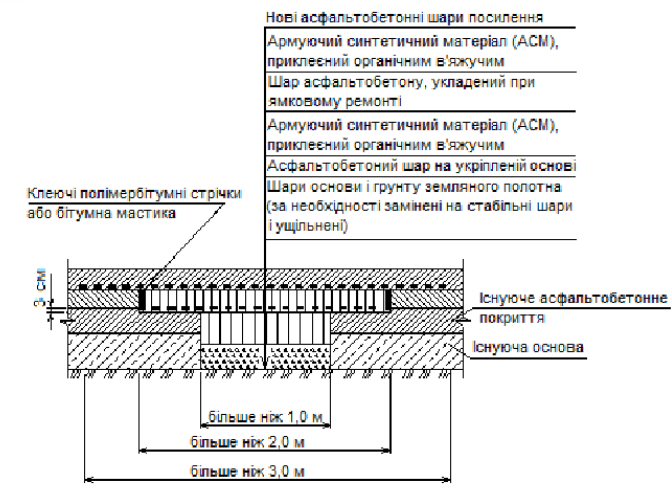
Схема ремонту наскрізних тріщин та підсилення конструкції дорожнього одягу новими асфальтобетонними шарами
